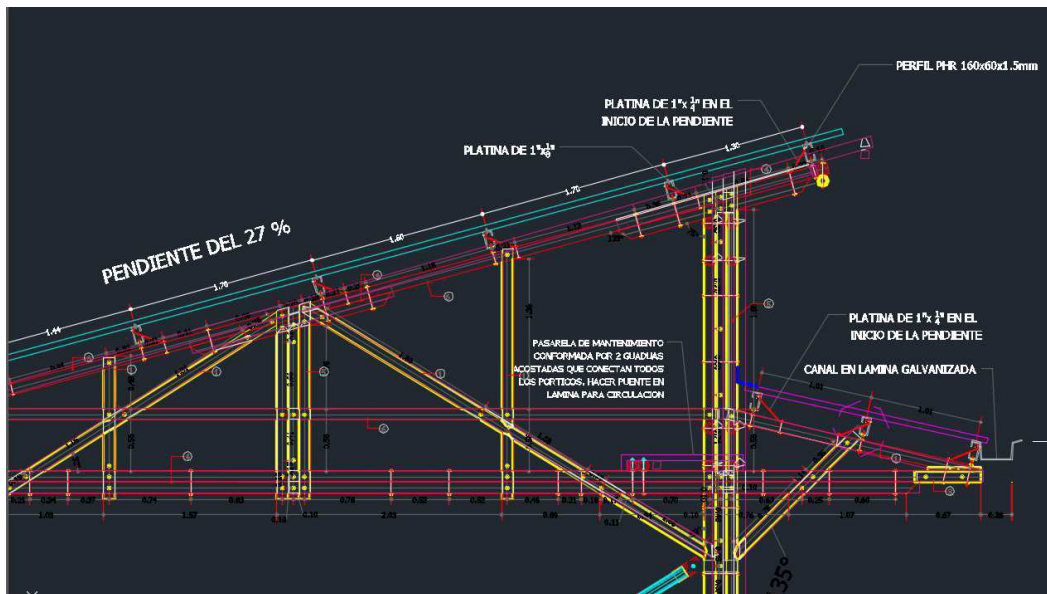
detalle de cubierta “plano estructural 10 de 14”
